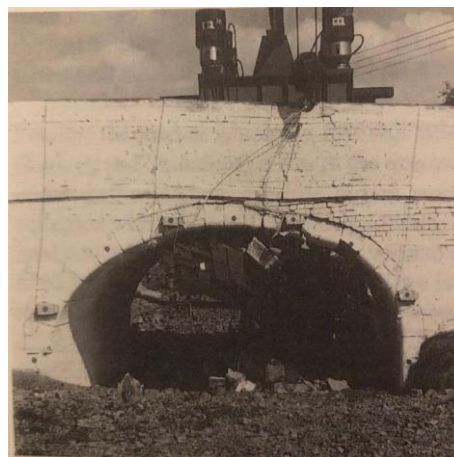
Preston Bridge*: prospetto ad est a seguito del collasso. [46]
